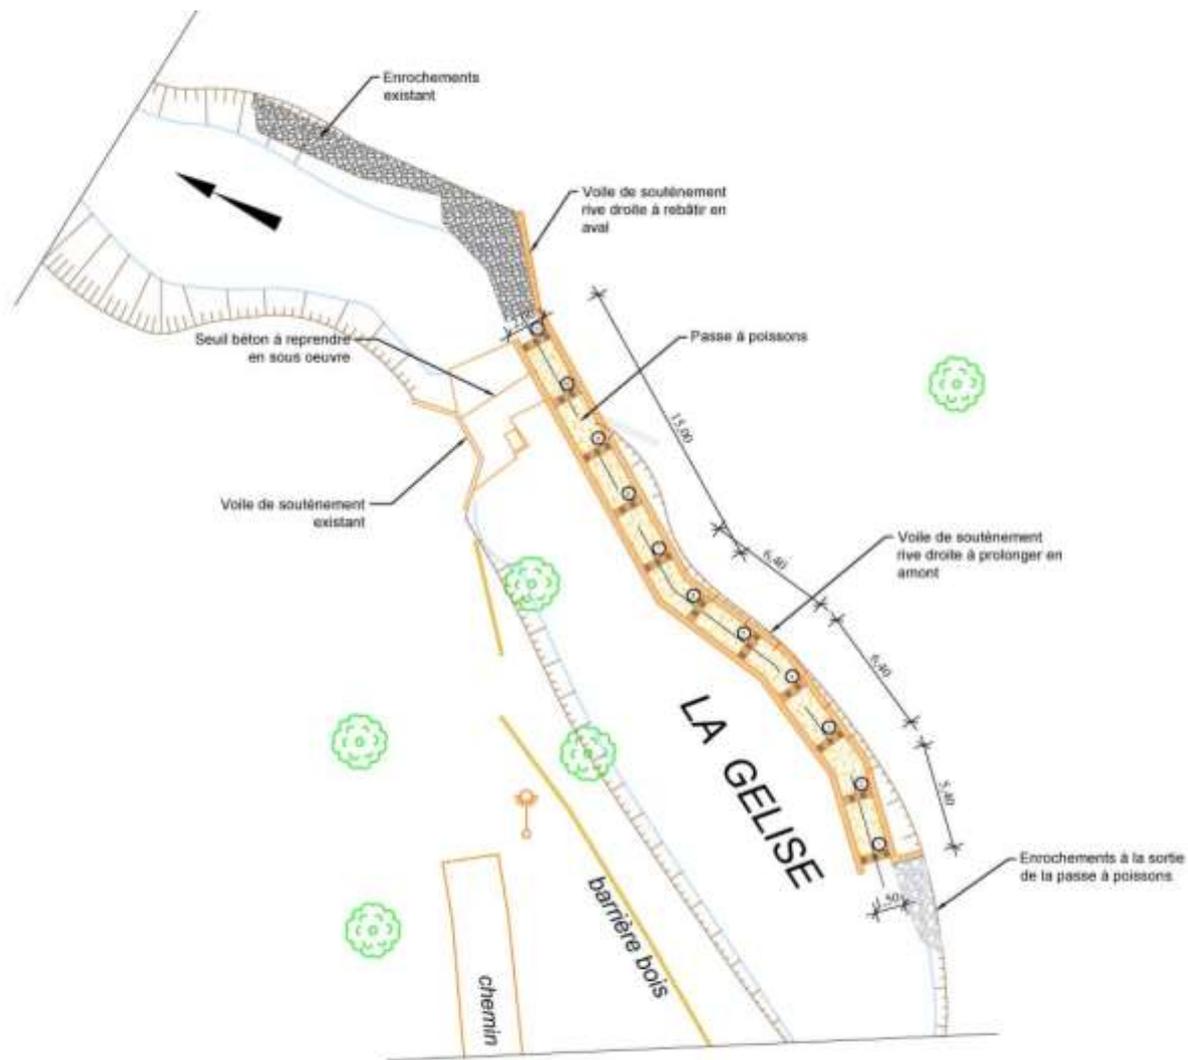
Schéma implantation passe à poissons au niveau du seuil béton
